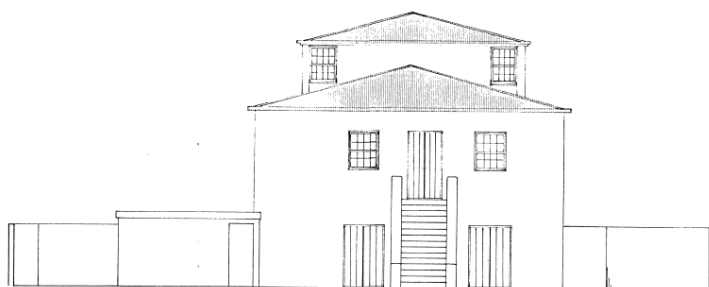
Alçado posterior da proposta - Esc. 1/200 – Autor do projeto
